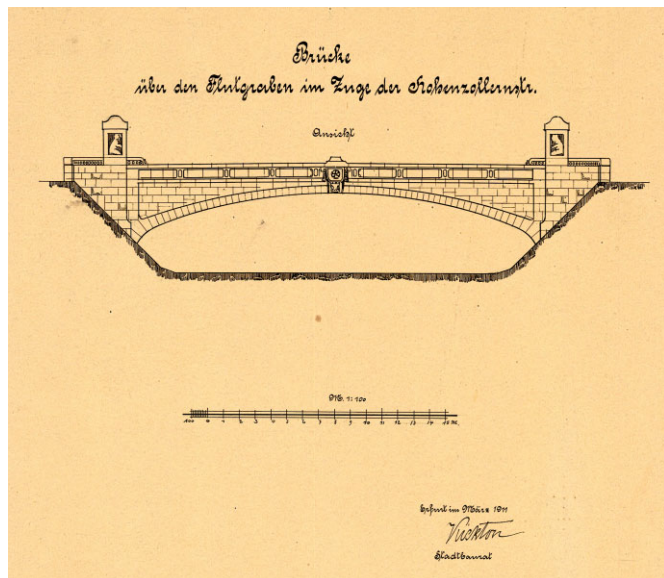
Hohenzollernbrücke – Bauwerksplan – HERMANN KICKTON – 1911
